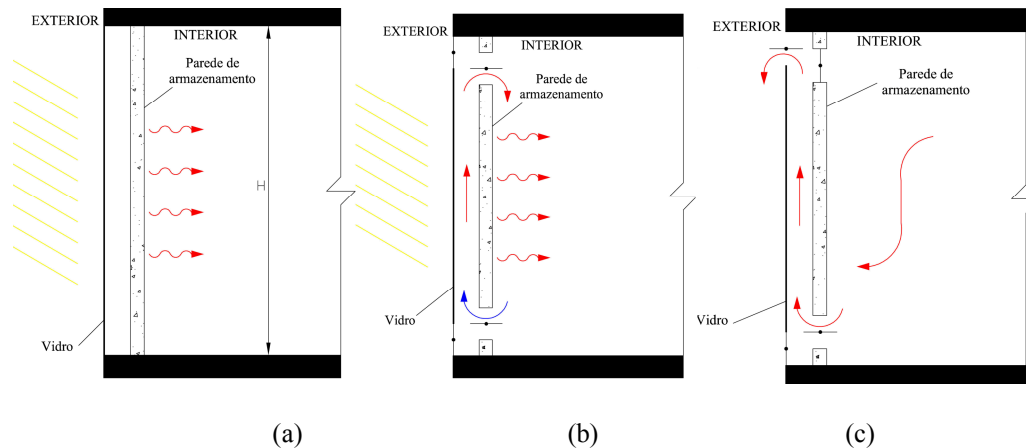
(a) Parede acumuladora ou Parede Trombe não ventilada; (b) Parede Trombe ventilada para situação de inverno; (c) Parede Trombe ventilada para situação de verão
